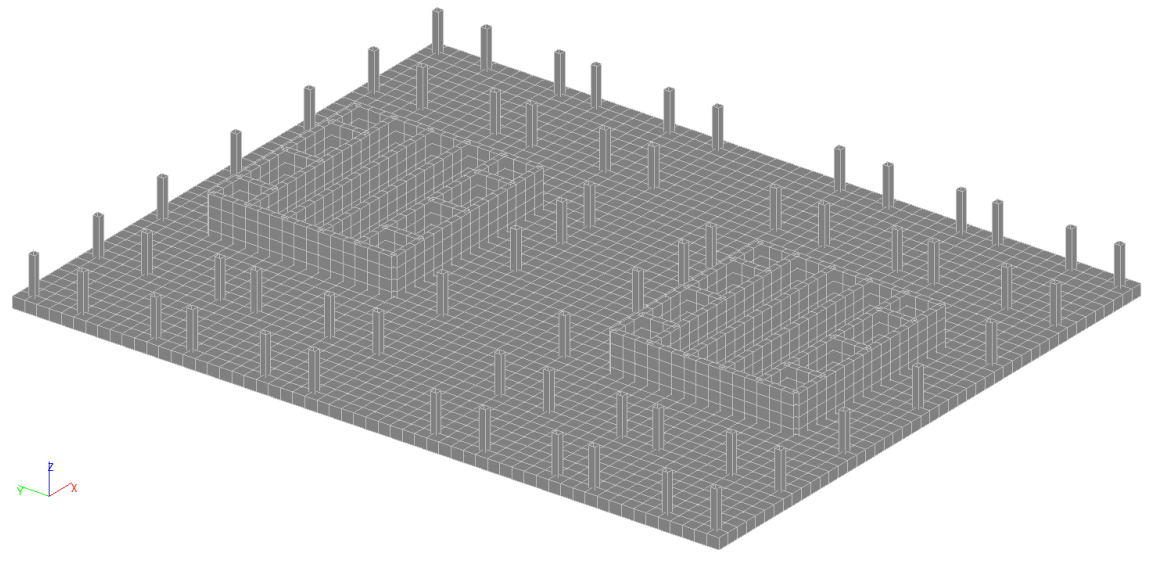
Конечно элементная схема фундаментной плиты
